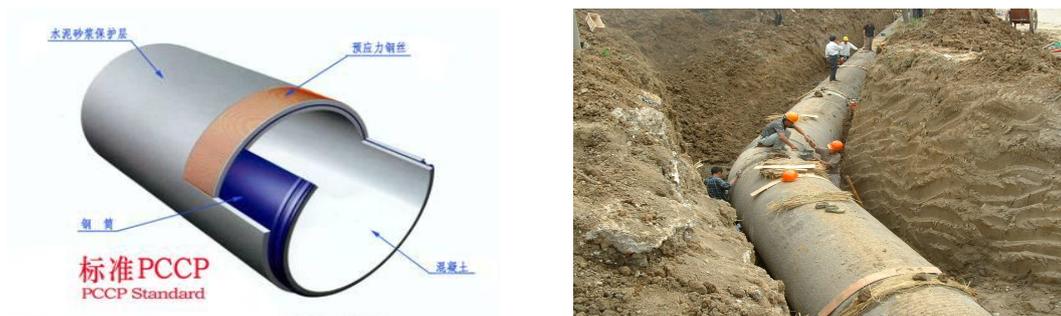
钢筒混凝土管示意图及使用实例
